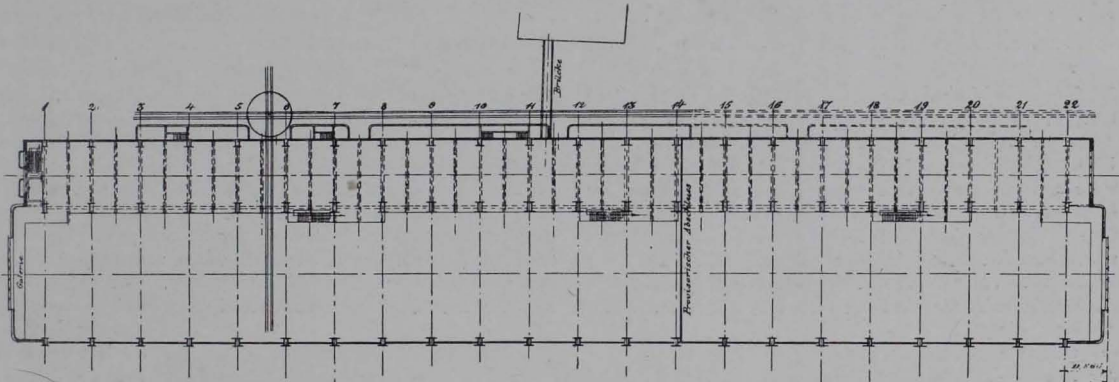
Turbinenhalle der AEG, Ecke Hutten- und Berlichingenstraße, in Berlin-Moabit. 1909. Grundriß des Erdgeschosses
